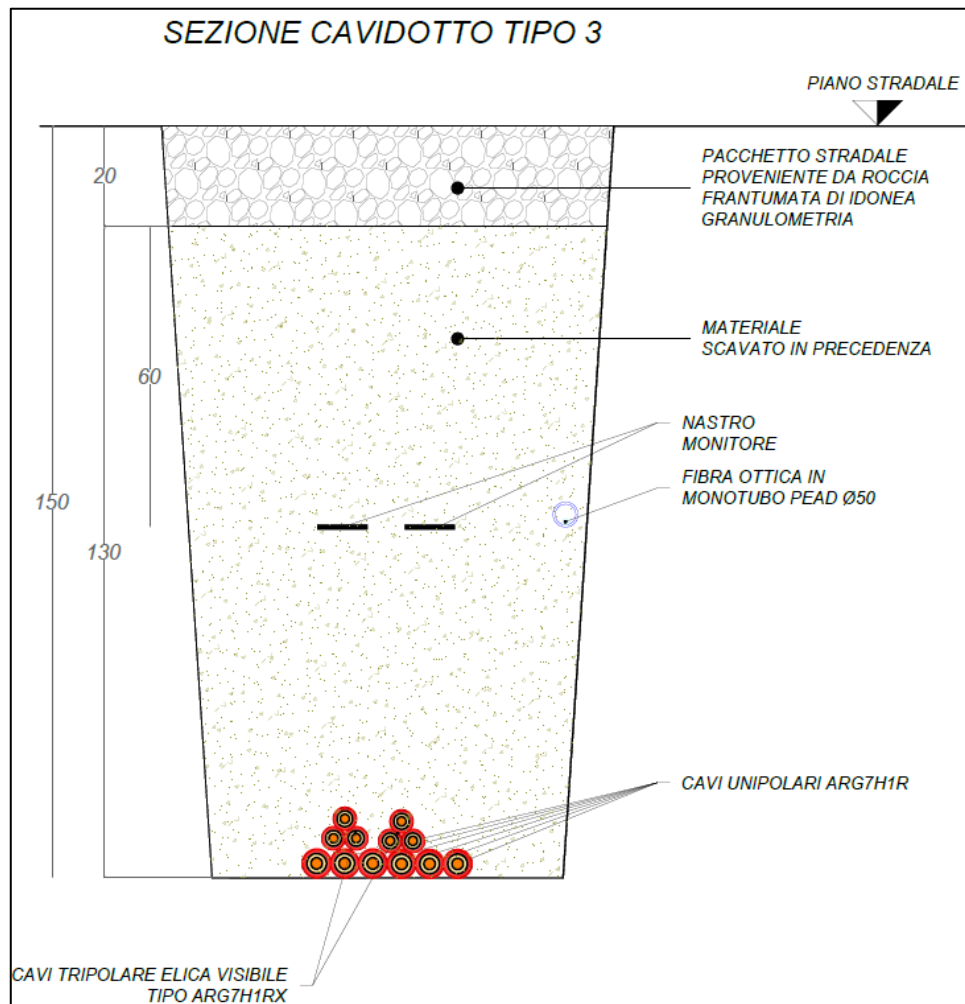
Sezione di posa cavidotto MT a 30 kV – tipo 3
